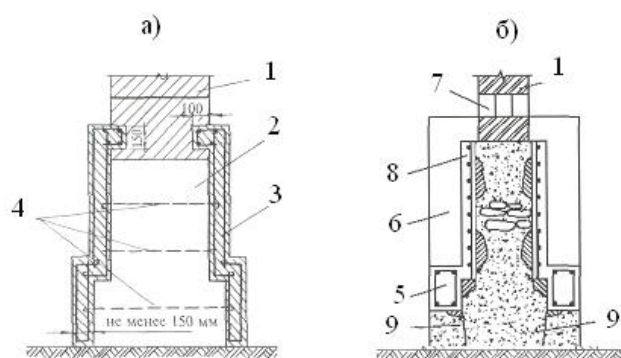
Усиление ленточного фундамента железобетонной обоймой (а) или железобетонной рубашкой, продольных железобетонных балок и контрфорсов (б):
